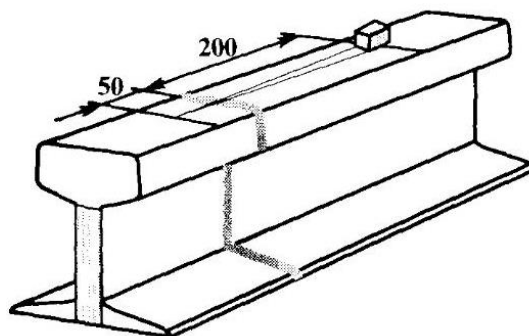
Схема прозвучивания шейки и участка подошвы под шейкой с поверхности катания головки рельса
